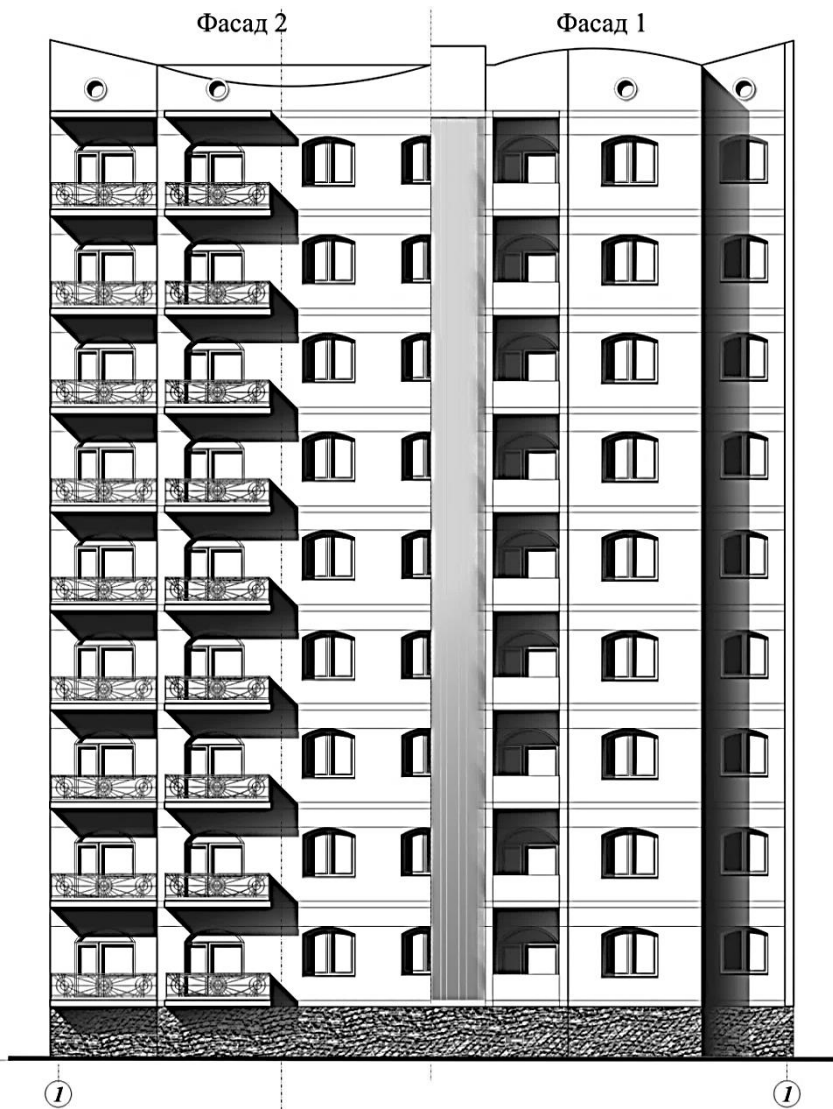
Архітурні рішення суміщених фасадів будинку А
